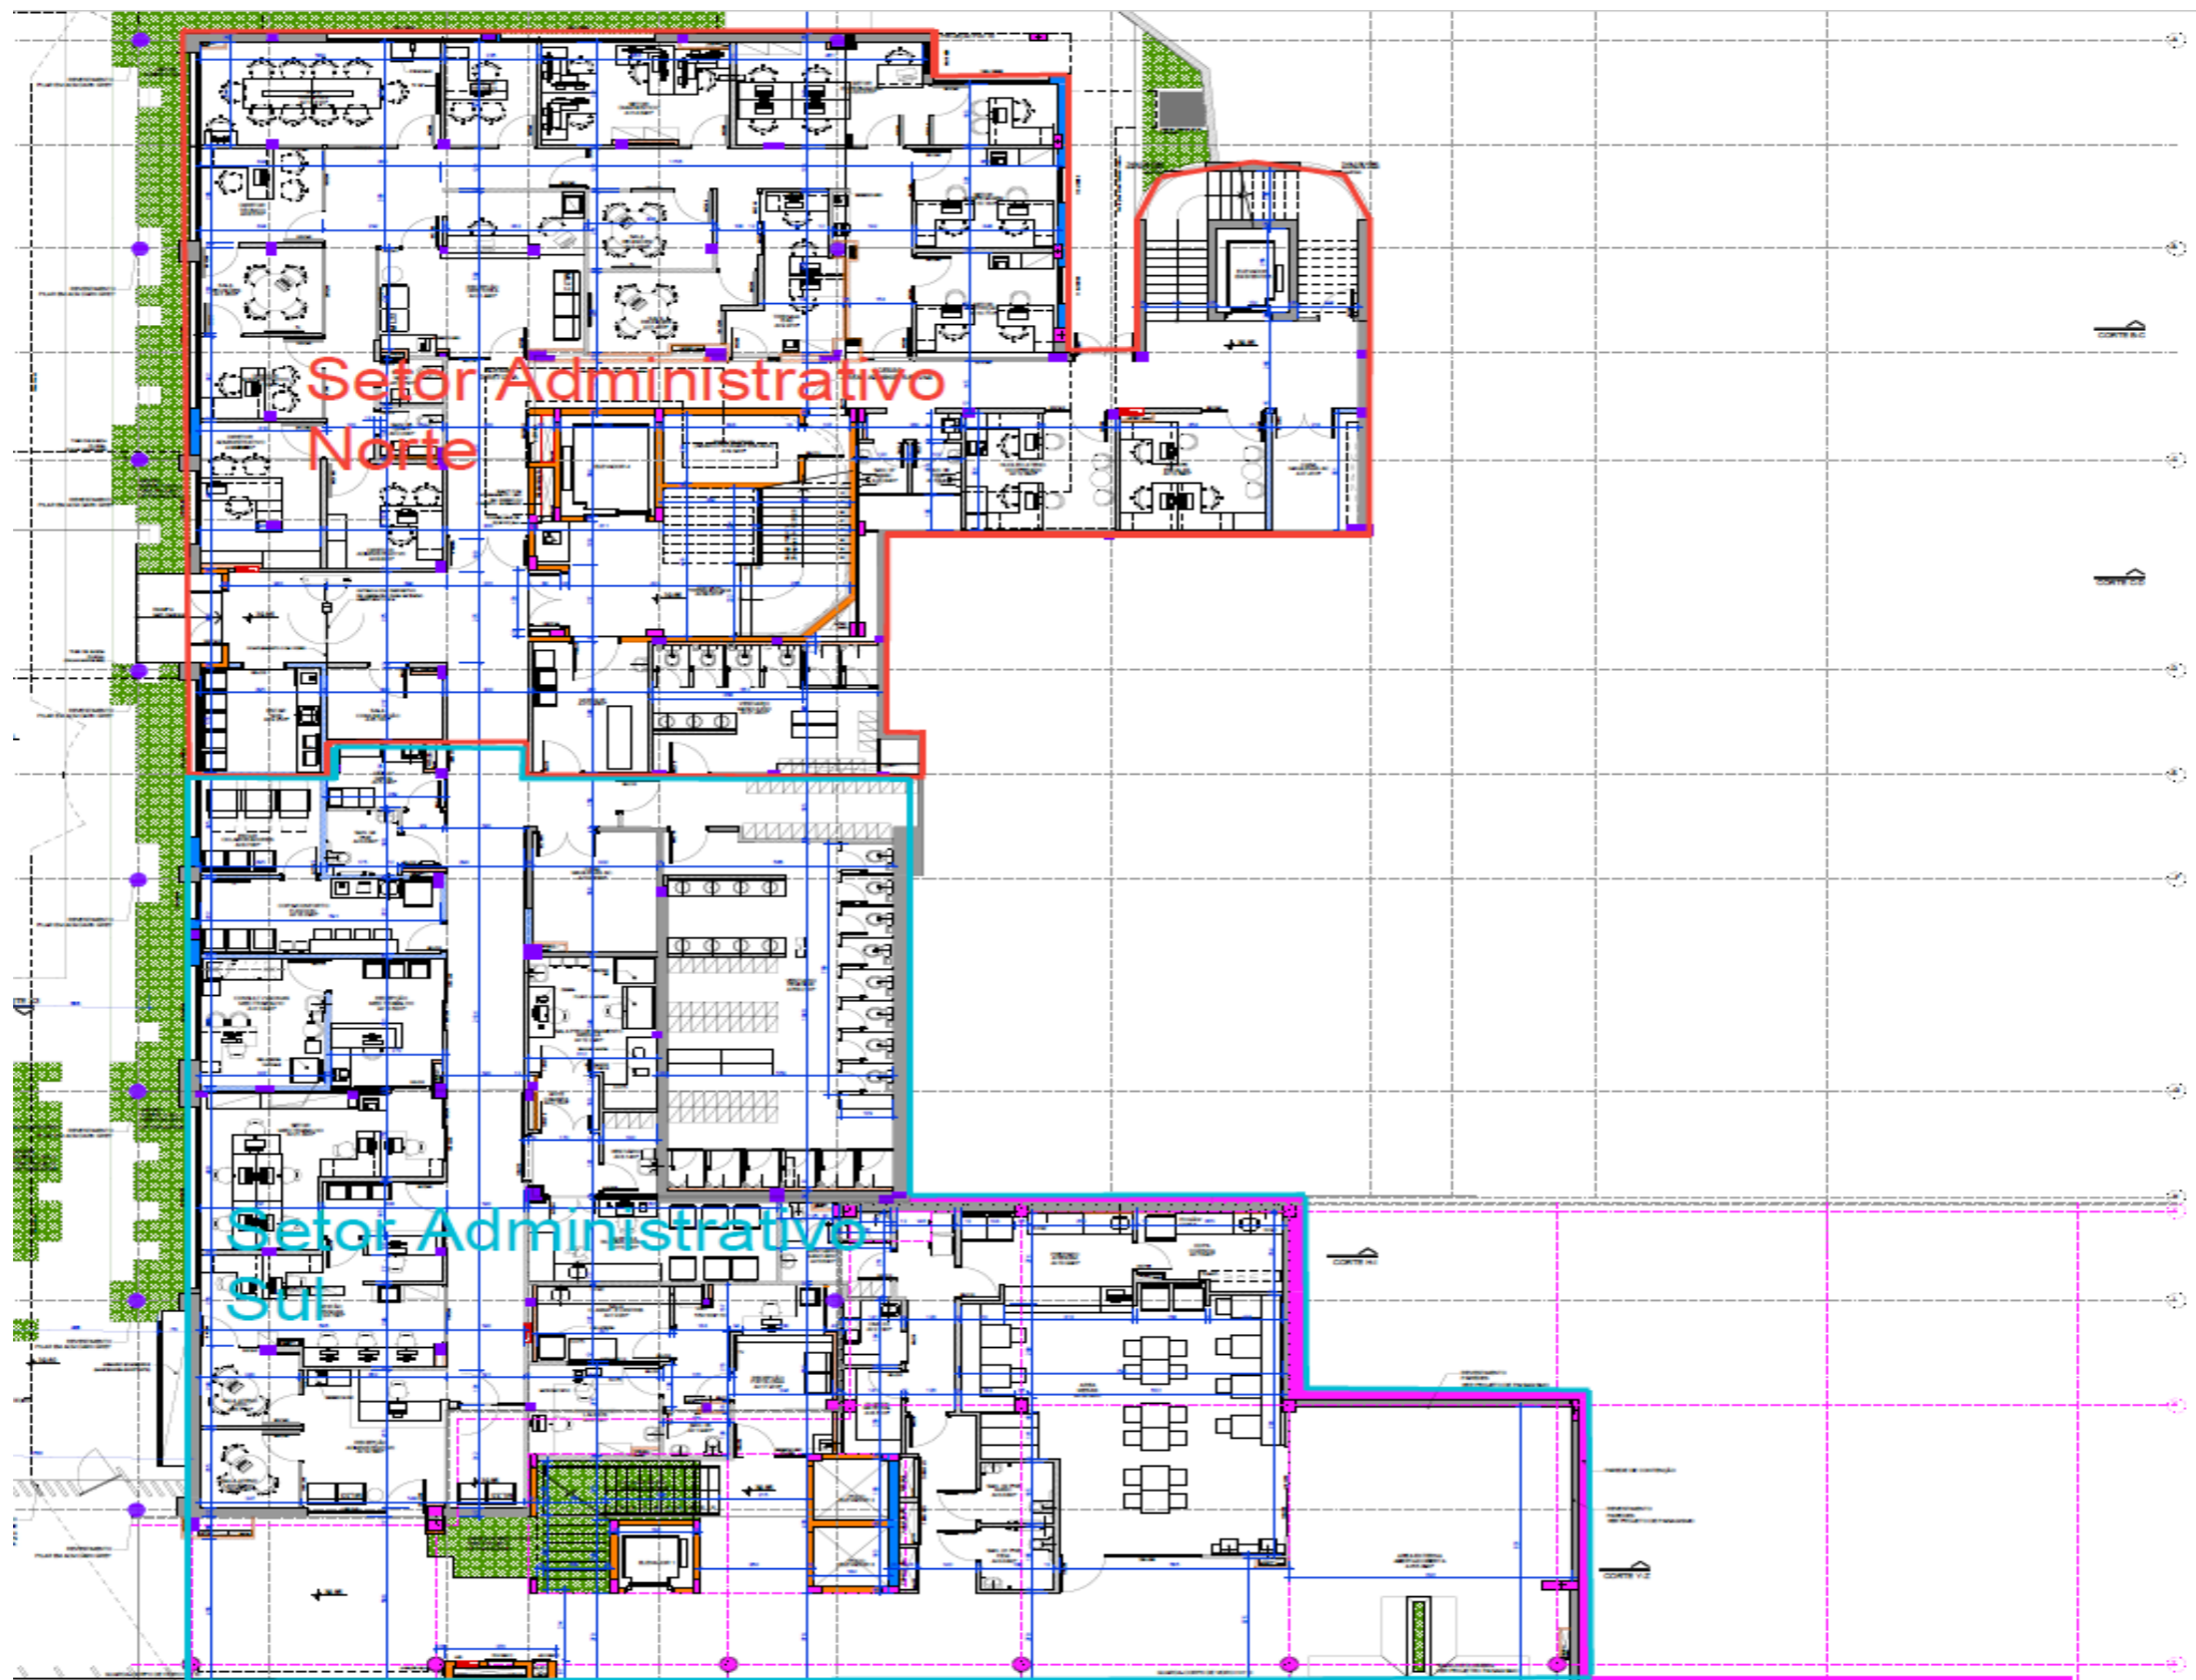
Novas Zonas de trabalho – Pavimento térreo
